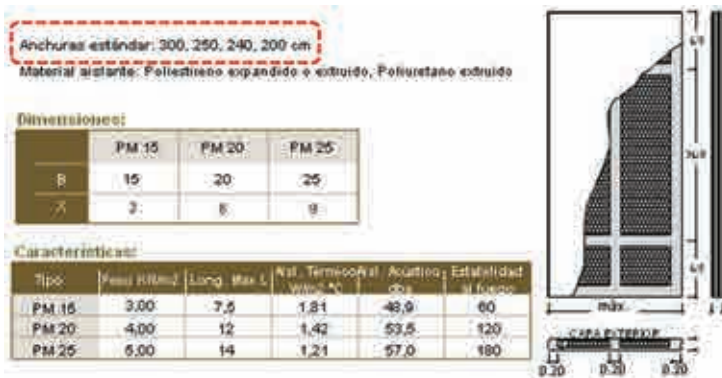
Recomendaciones geométricas para paneles de fachada de la empresa de prefabricados HORMIPRESA
